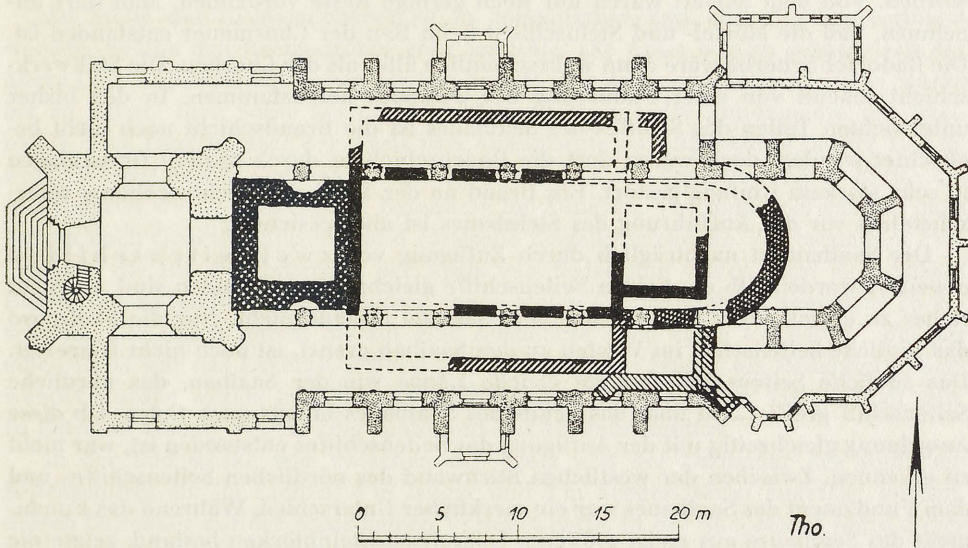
Grundriß der Pfarrkirche in Erkelenz mit älteren Bauresten.
